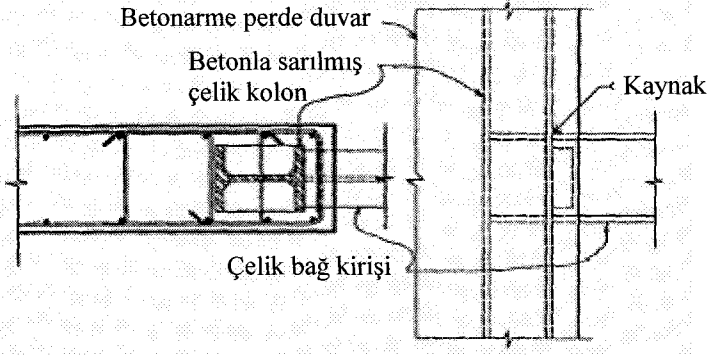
Kısmi olarak betonla sarılmış çelik uç/başlık elemanı [7]
